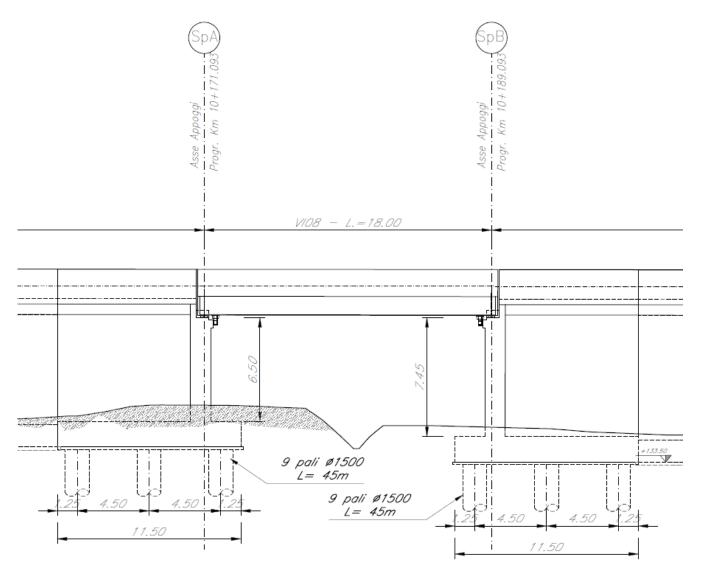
Spalla scatolare doppio binario – prospetto longitudinale
